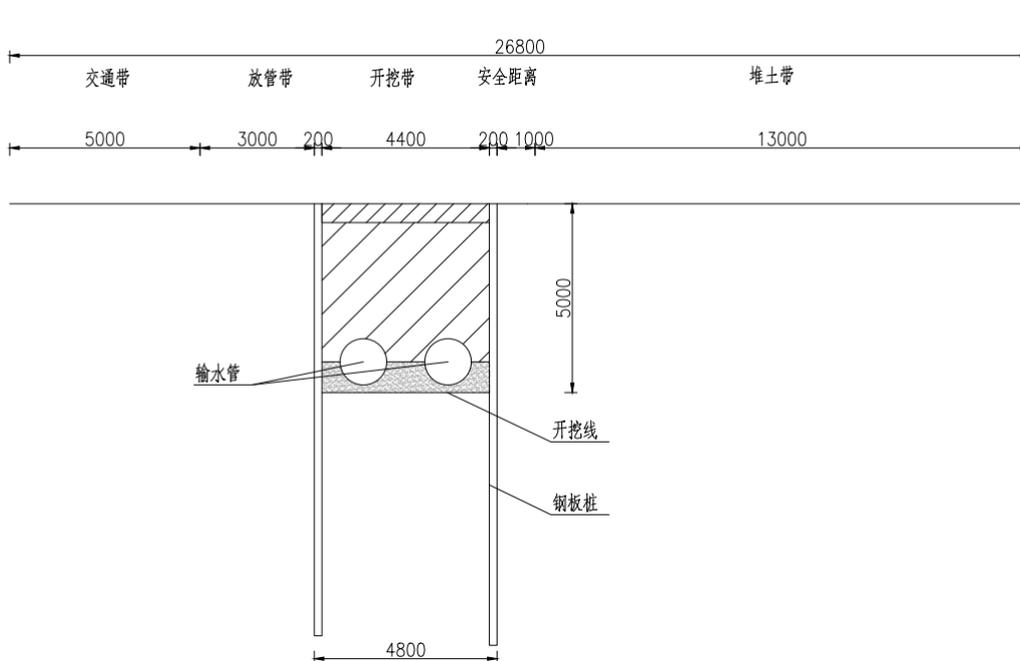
钢板桩支护开挖段作业带设置断面图
